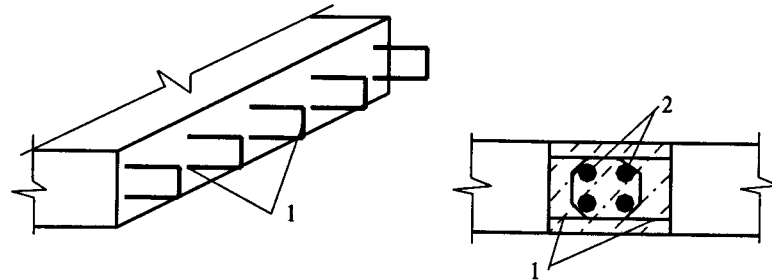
Сборно-монолитный стык: 1 — петлевые выпуски арматуры; 2 — продольная арматура, пропущенная через петлевые выпуски арматуры
